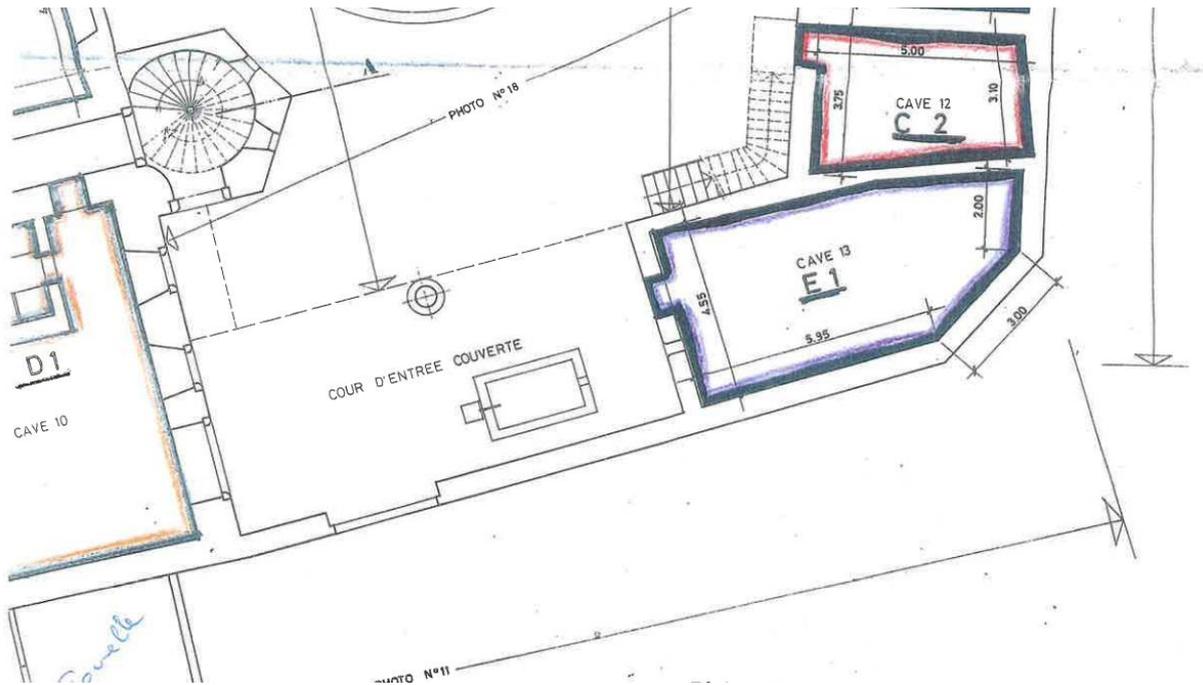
Plan du rez-de-chaussée (cave E1)
